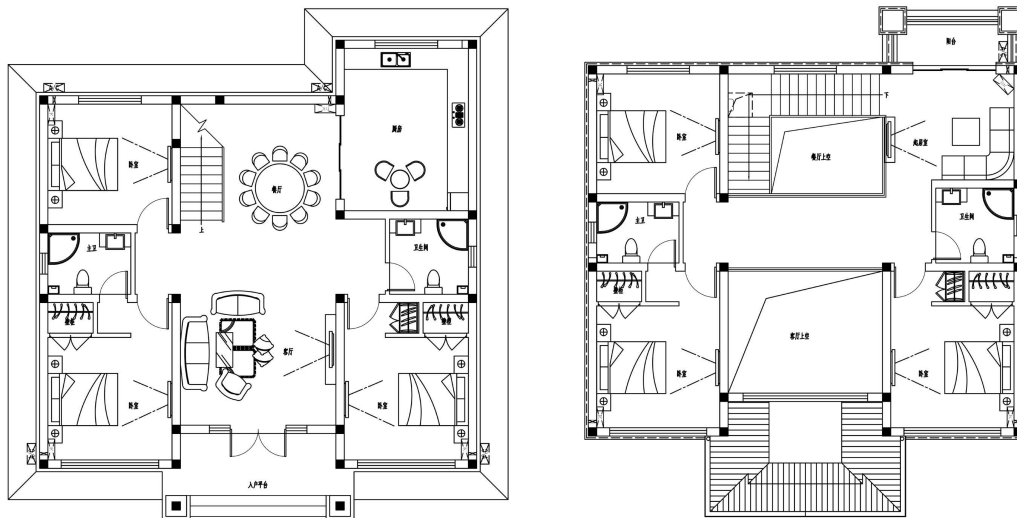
二层现代宜居农房一层平面图示例 图 B.0.4 二层现代宜居农房二层平面图示例
